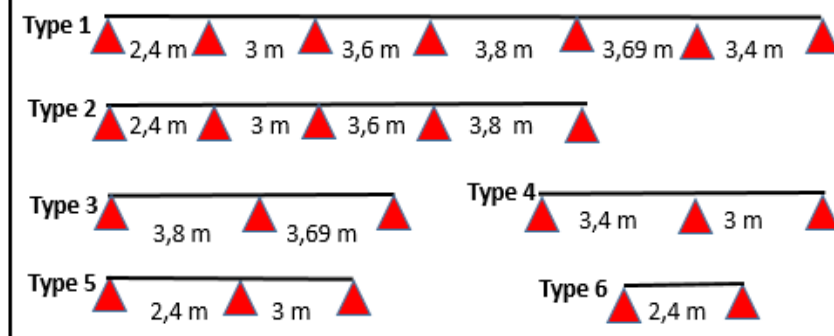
Types de poutrelles dans l'étage commerciale
